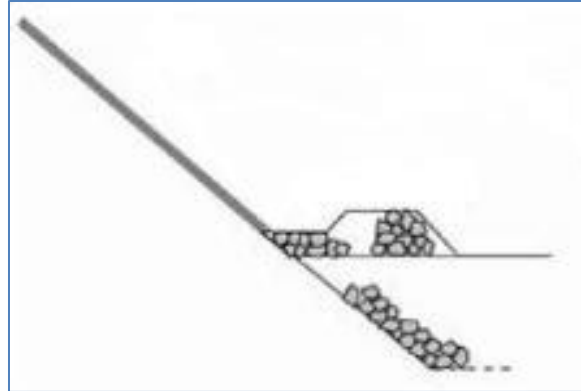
Protección de orillas con formaleta textil rellena de concreto y trinchera de empotramiento
